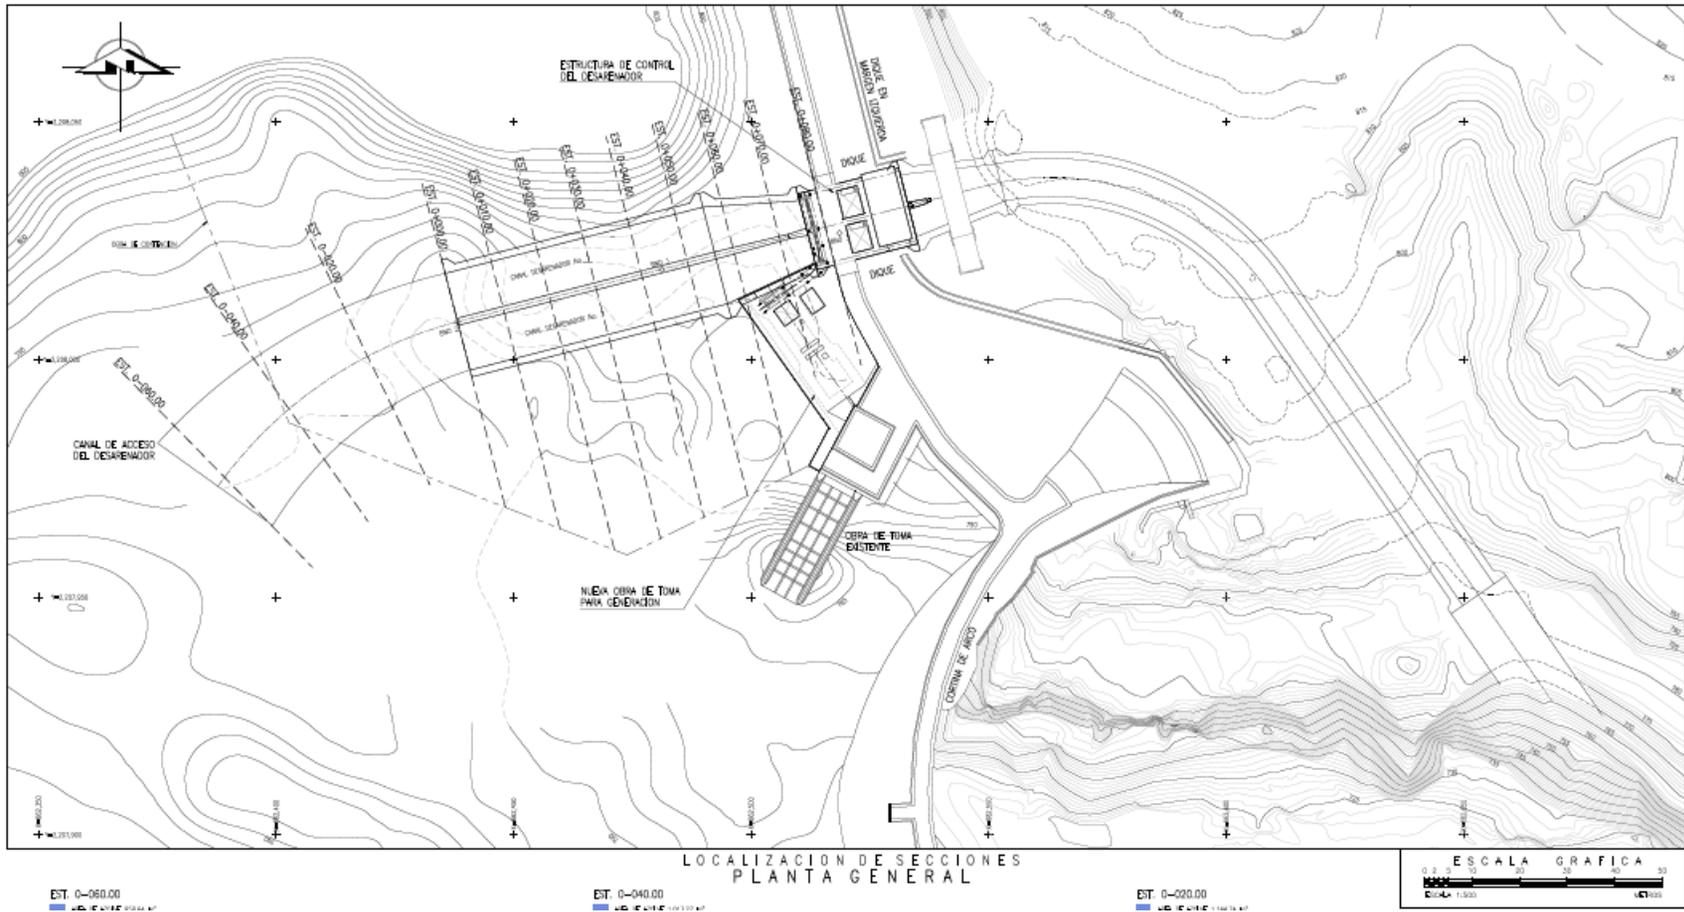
Planta general del proyecto de la nueva obra de toma con desarenador en la presa la soledad.⁵
